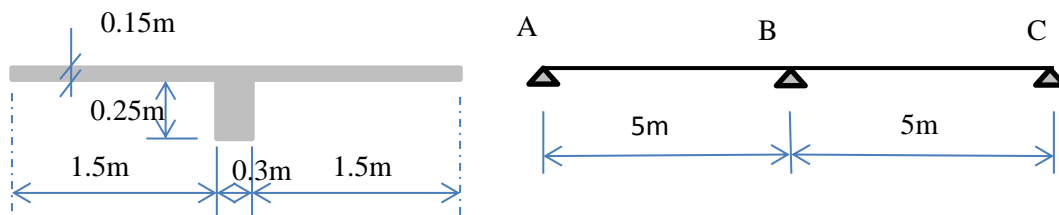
Schéma de principe de la poutre de plancher à étudier
